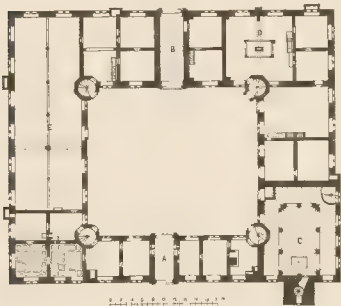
Grundriss der Wilhelmsburg (Erdgeschoss). Nach Luebke
